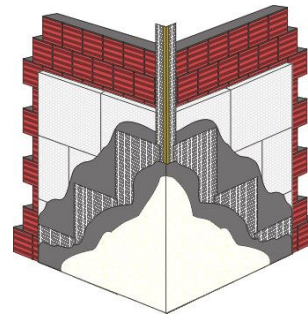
Parede com Isolamento Exterior. ©Dryvit
